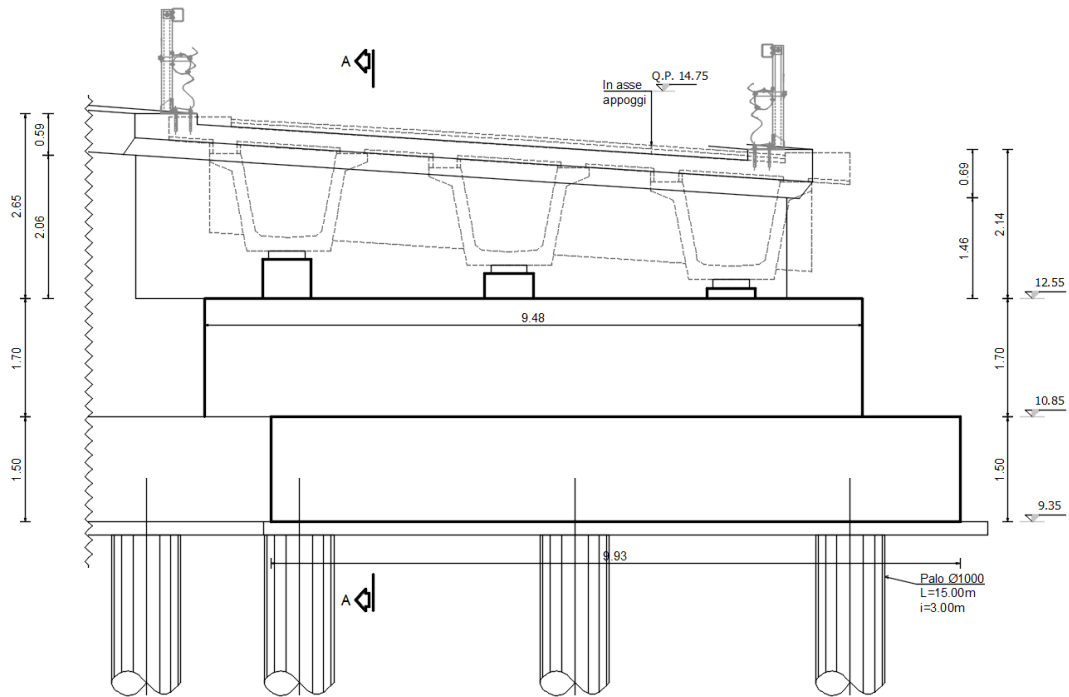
Prospetto spalla "SB" lato Ramo Bidirezionale 1
